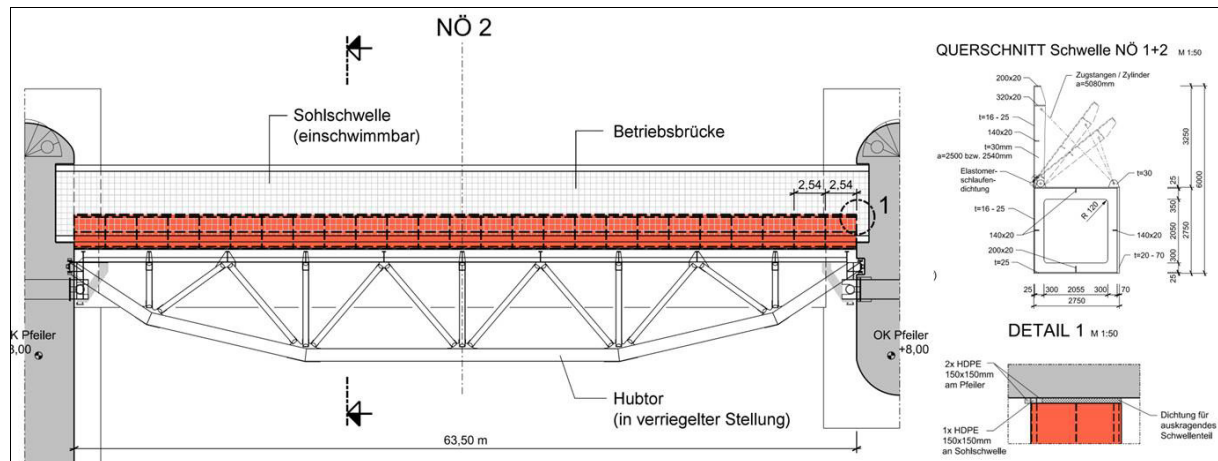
Variante T.2.c, einschwimmbare Sohlschwelle, Draufsicht und Details
